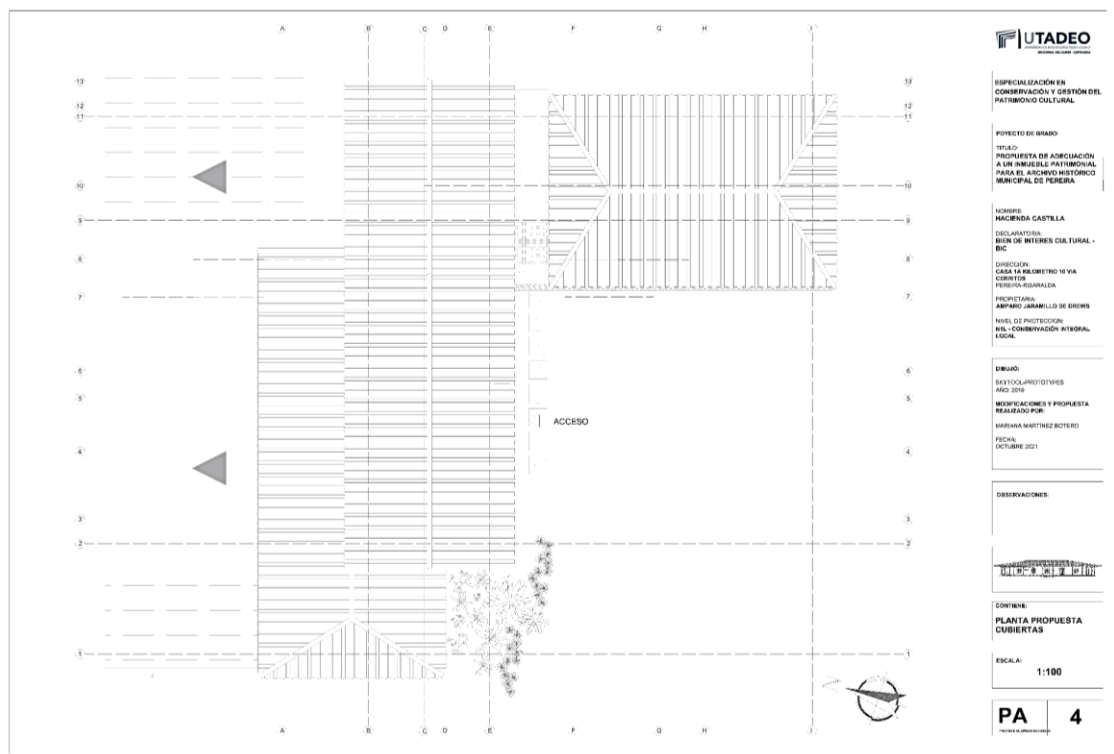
Propuesta Arquitectónica- Planta cubiertas Casa Roja- Fuente Propia
